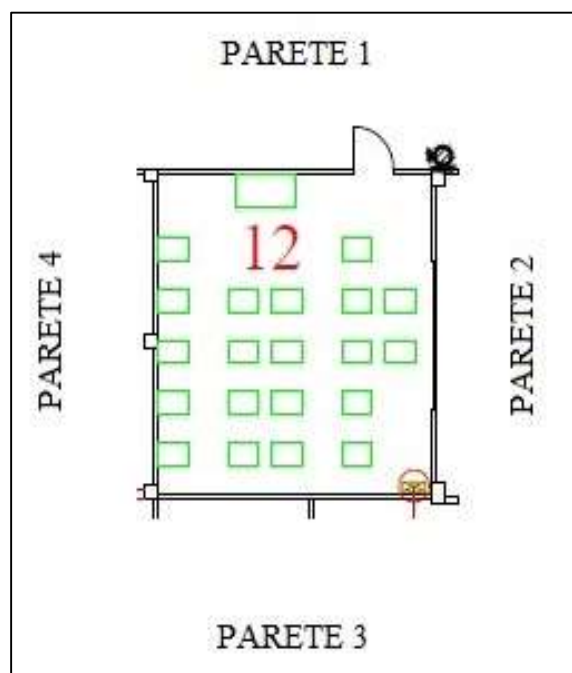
Planimetria dell'Aula 12 (5°A) oggetto di misurazioni
